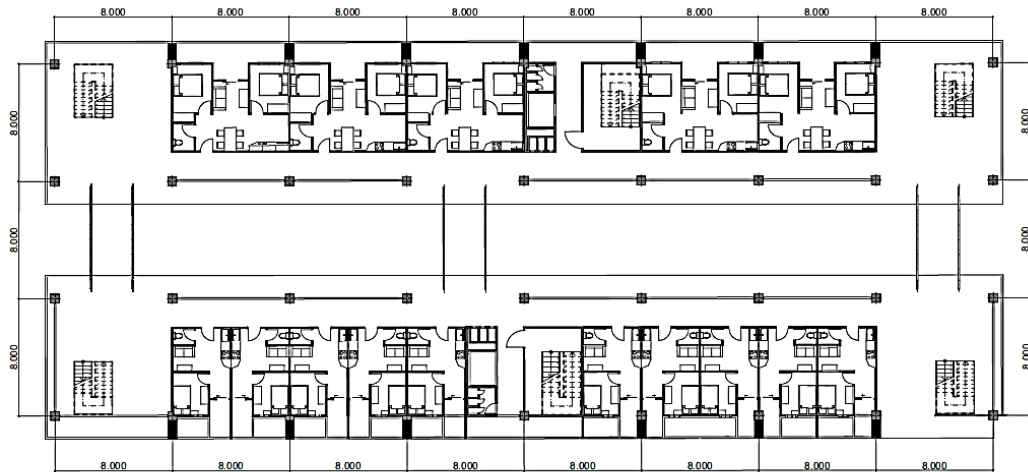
Layout dan Besaran Ruang Tipe 2 Kamar
